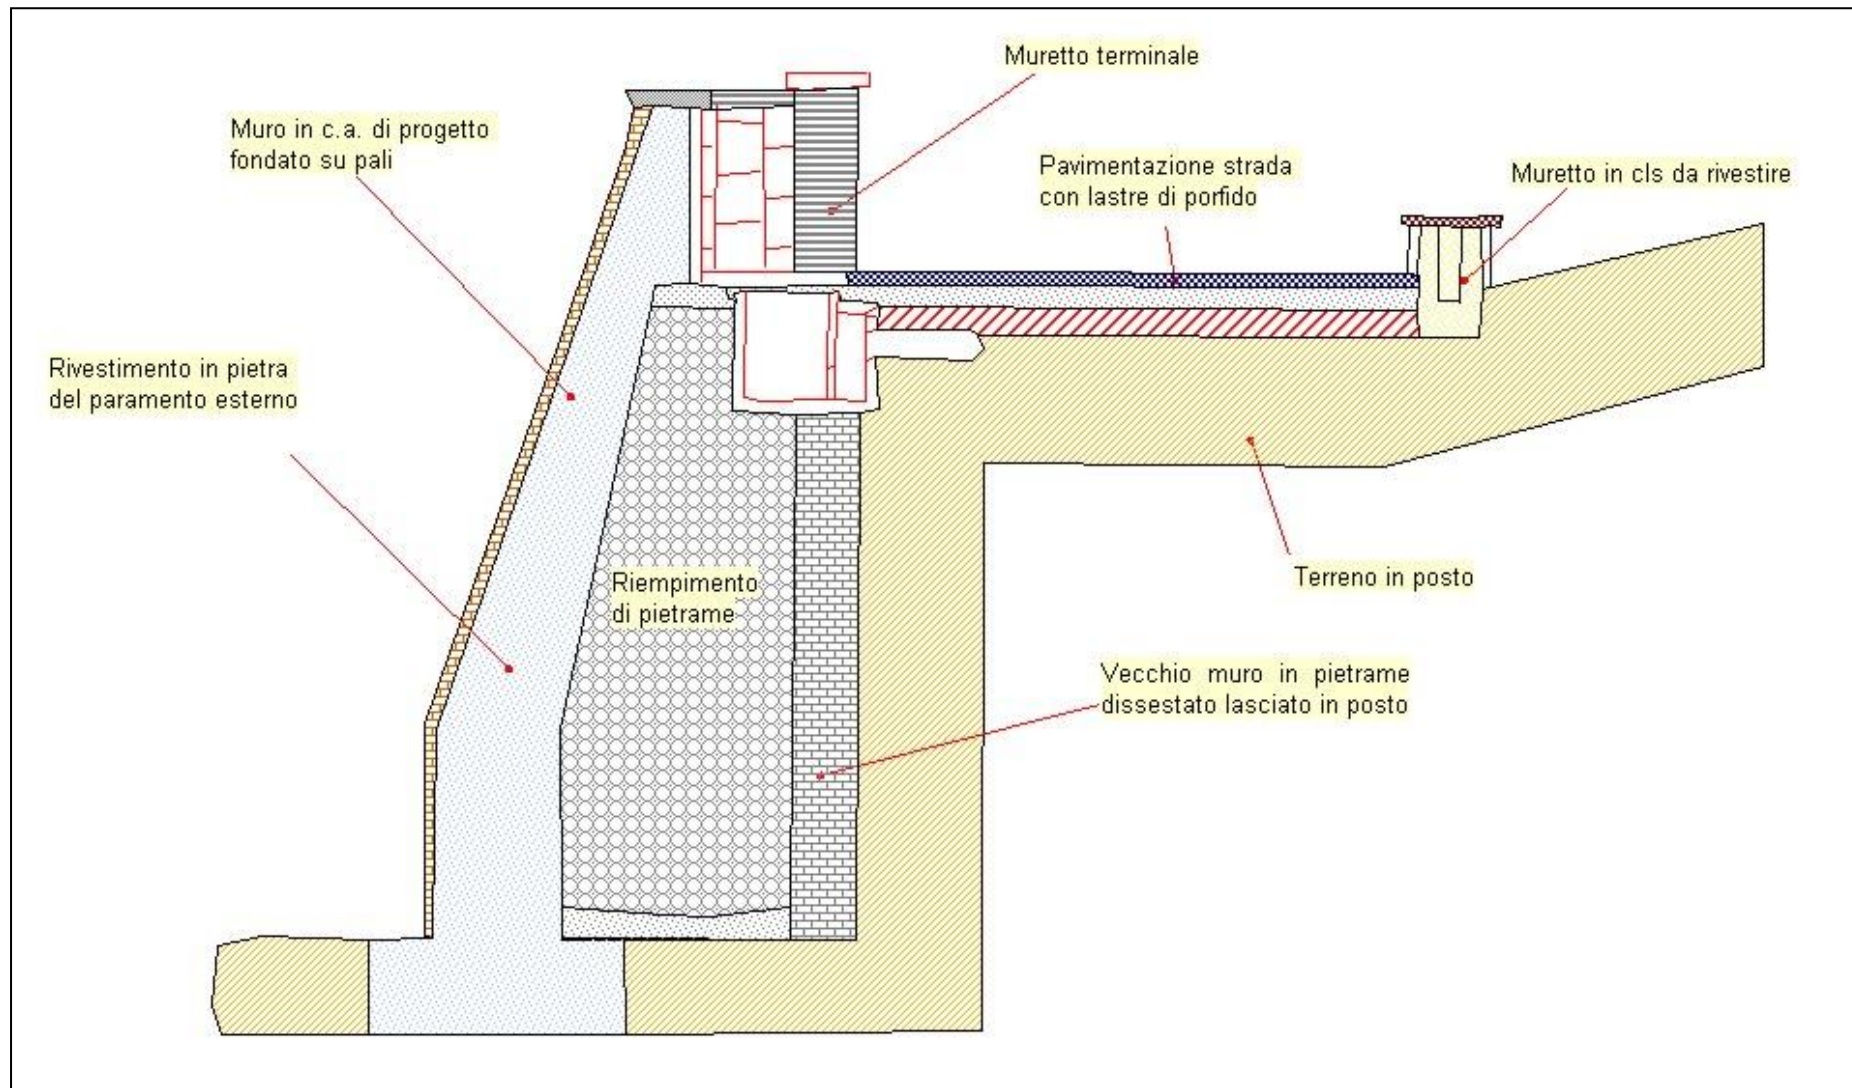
Schizzo Sezione del muro di sostegno ricostruito e della strada (ridisegnato da progetto esecutivo).
